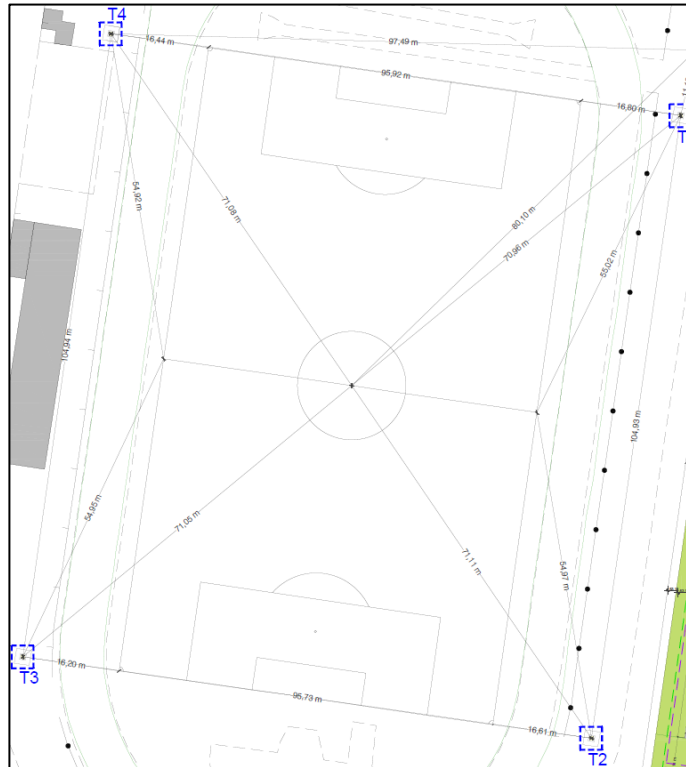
Planimetria Campo Principale con indicazione delle torri faro
